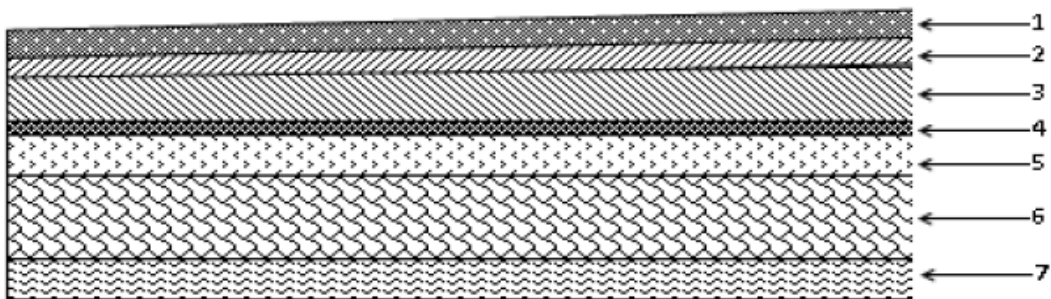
Coupe transversale du plancher terrasse inaccessible.
